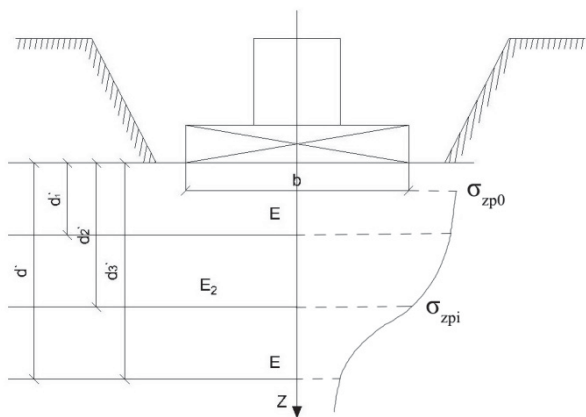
Схема розподілу тиску під подошвою фундаменту / Fig. 1. Pressure distribution pattern under the base of the foundation
